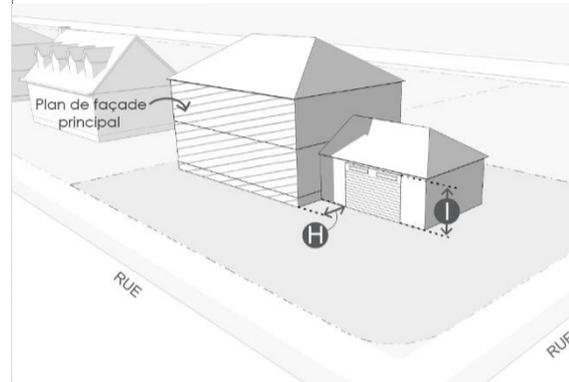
Retrait d'un garage par rapport à un plan de façade principal et hauteur d'une porte de garage
